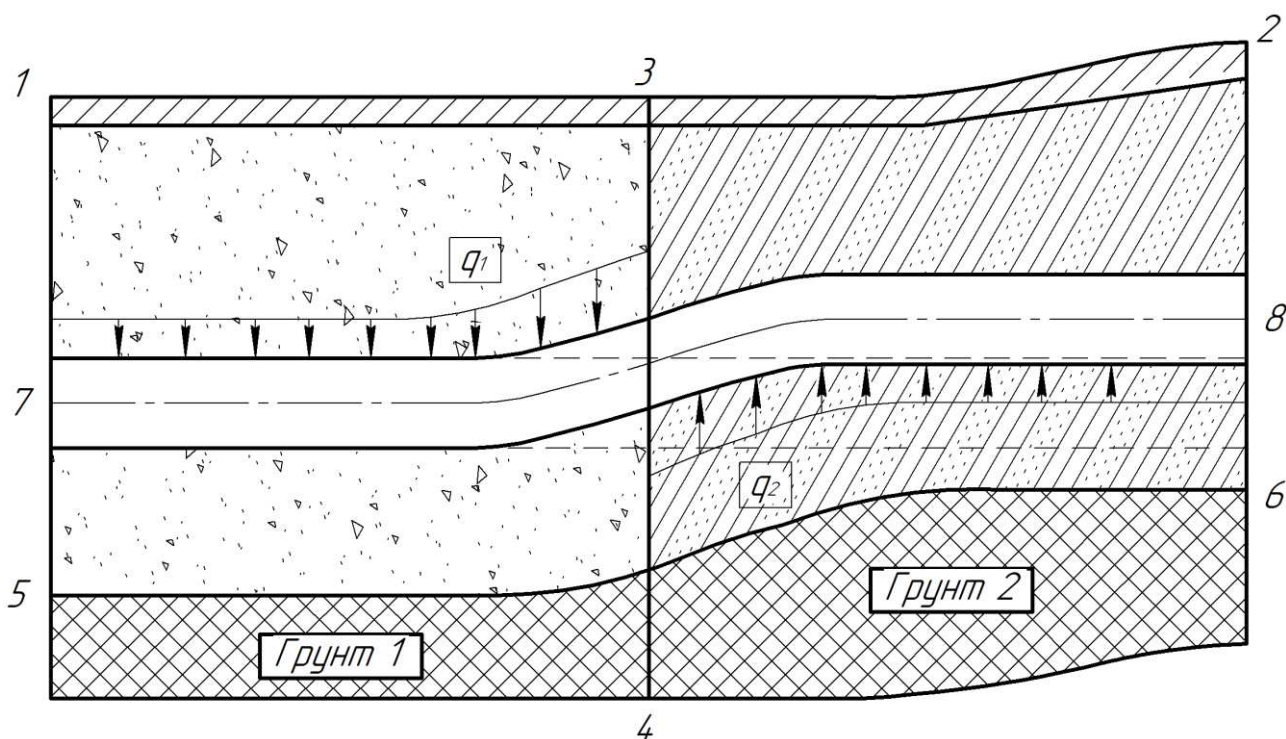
Схема взаимодействия трубопровода с промерзающим грунтом на границе раздела грунтов: грунт 1 – непучинистый талый грунт; грунт 2 – пучинистый талый грунт; 1-2 – поверхность земли; 1-5-6-2 – грунты в мерзлом состоянии; 3-4 – условная граница раздела грунтов; 5-6 – нижний фронт промерзания; 7-8 – изогнутая ось трубопровода;  $q_1$  – погонная нагрузка сил отпора грунта;  $q_2$  – погонная нагрузка нормальных сил пучения грунта [10]
